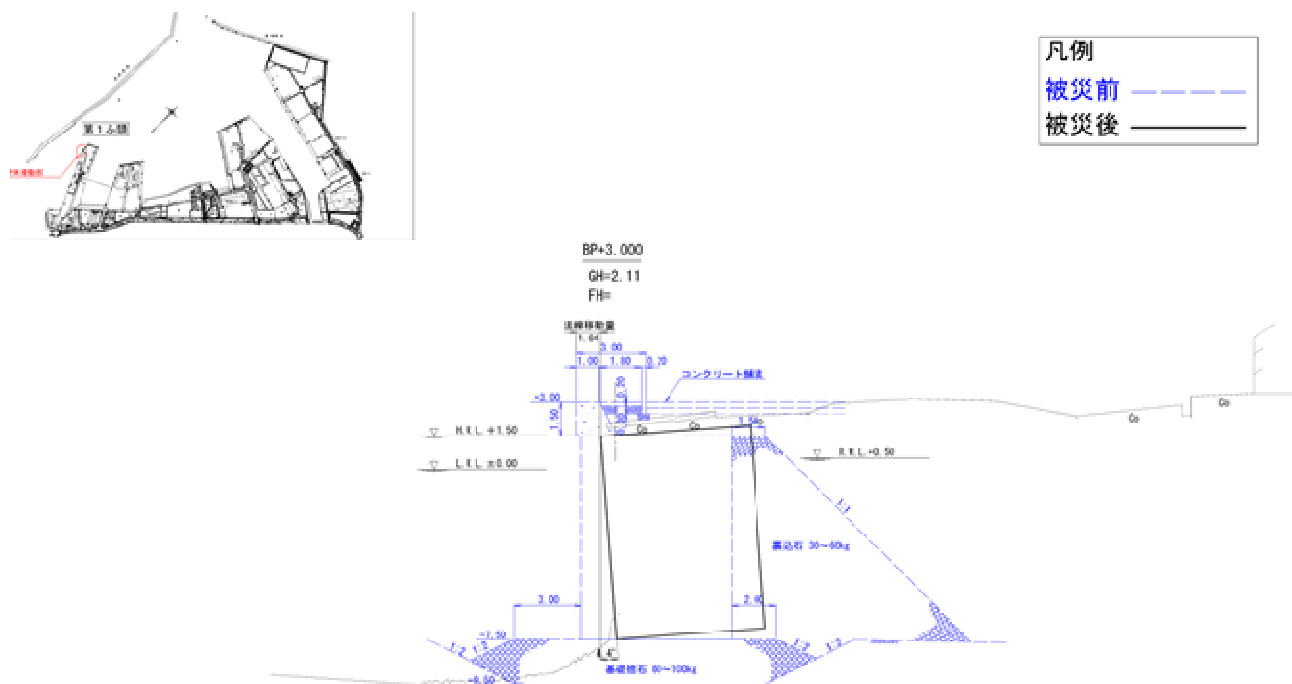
No.3 日立港区\_第1ふ頭地区 1-C 岸壁 (-7.5m) の断面図 (被災前・後)
